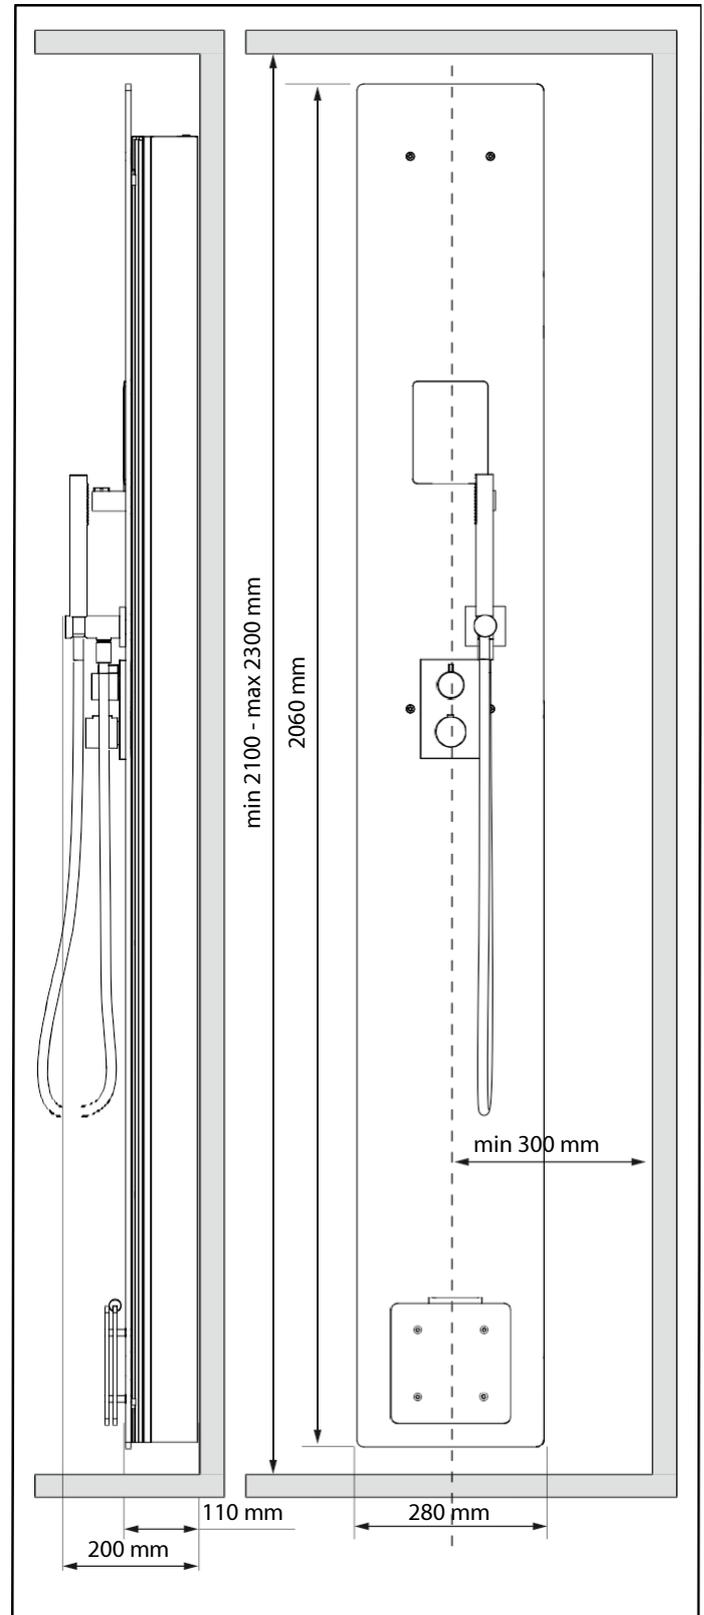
Dimensioni in millimetri, colonna di vapore tipo Stella
